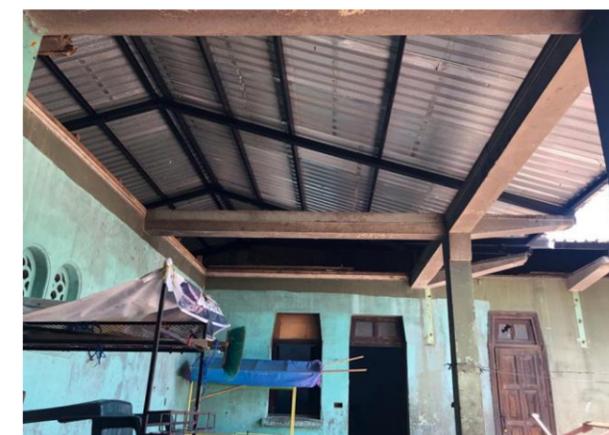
Estructura metálica y cubierta de zinc. Fuente: propia.
